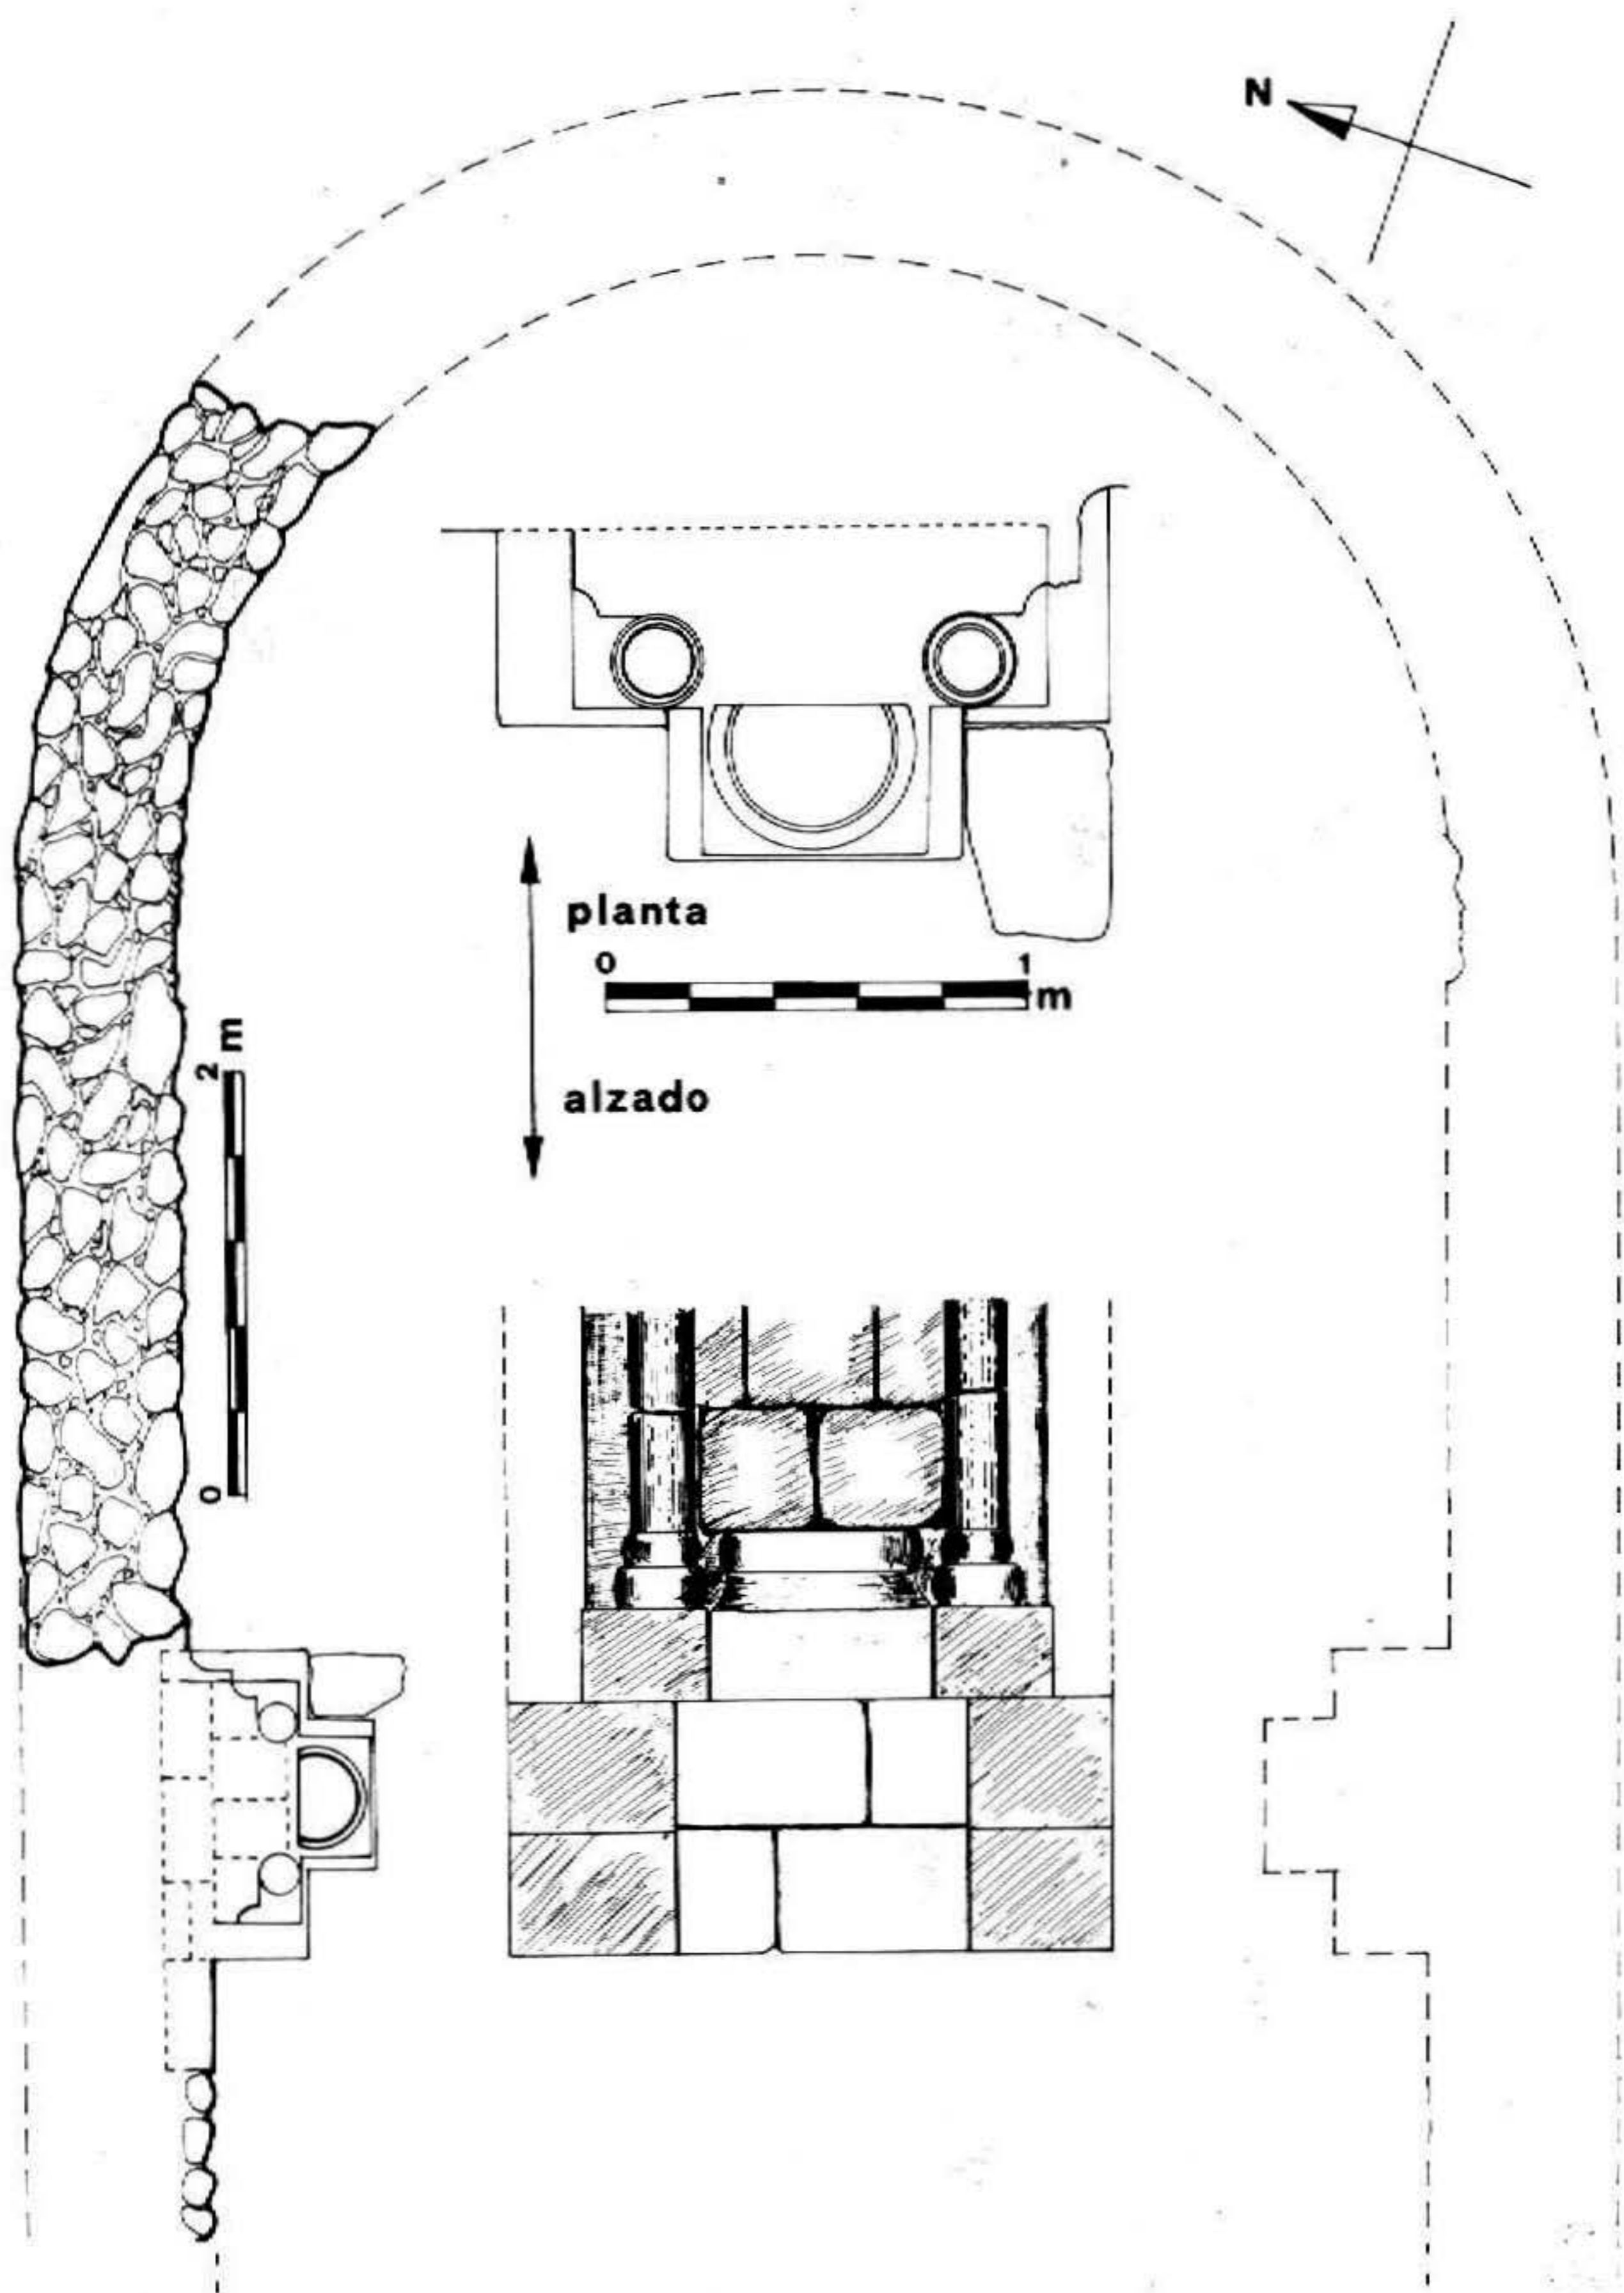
Plano de la iglesia de San Pedro de Brihuega. En el centro, planta y alzado de la base del arco triunfal.
